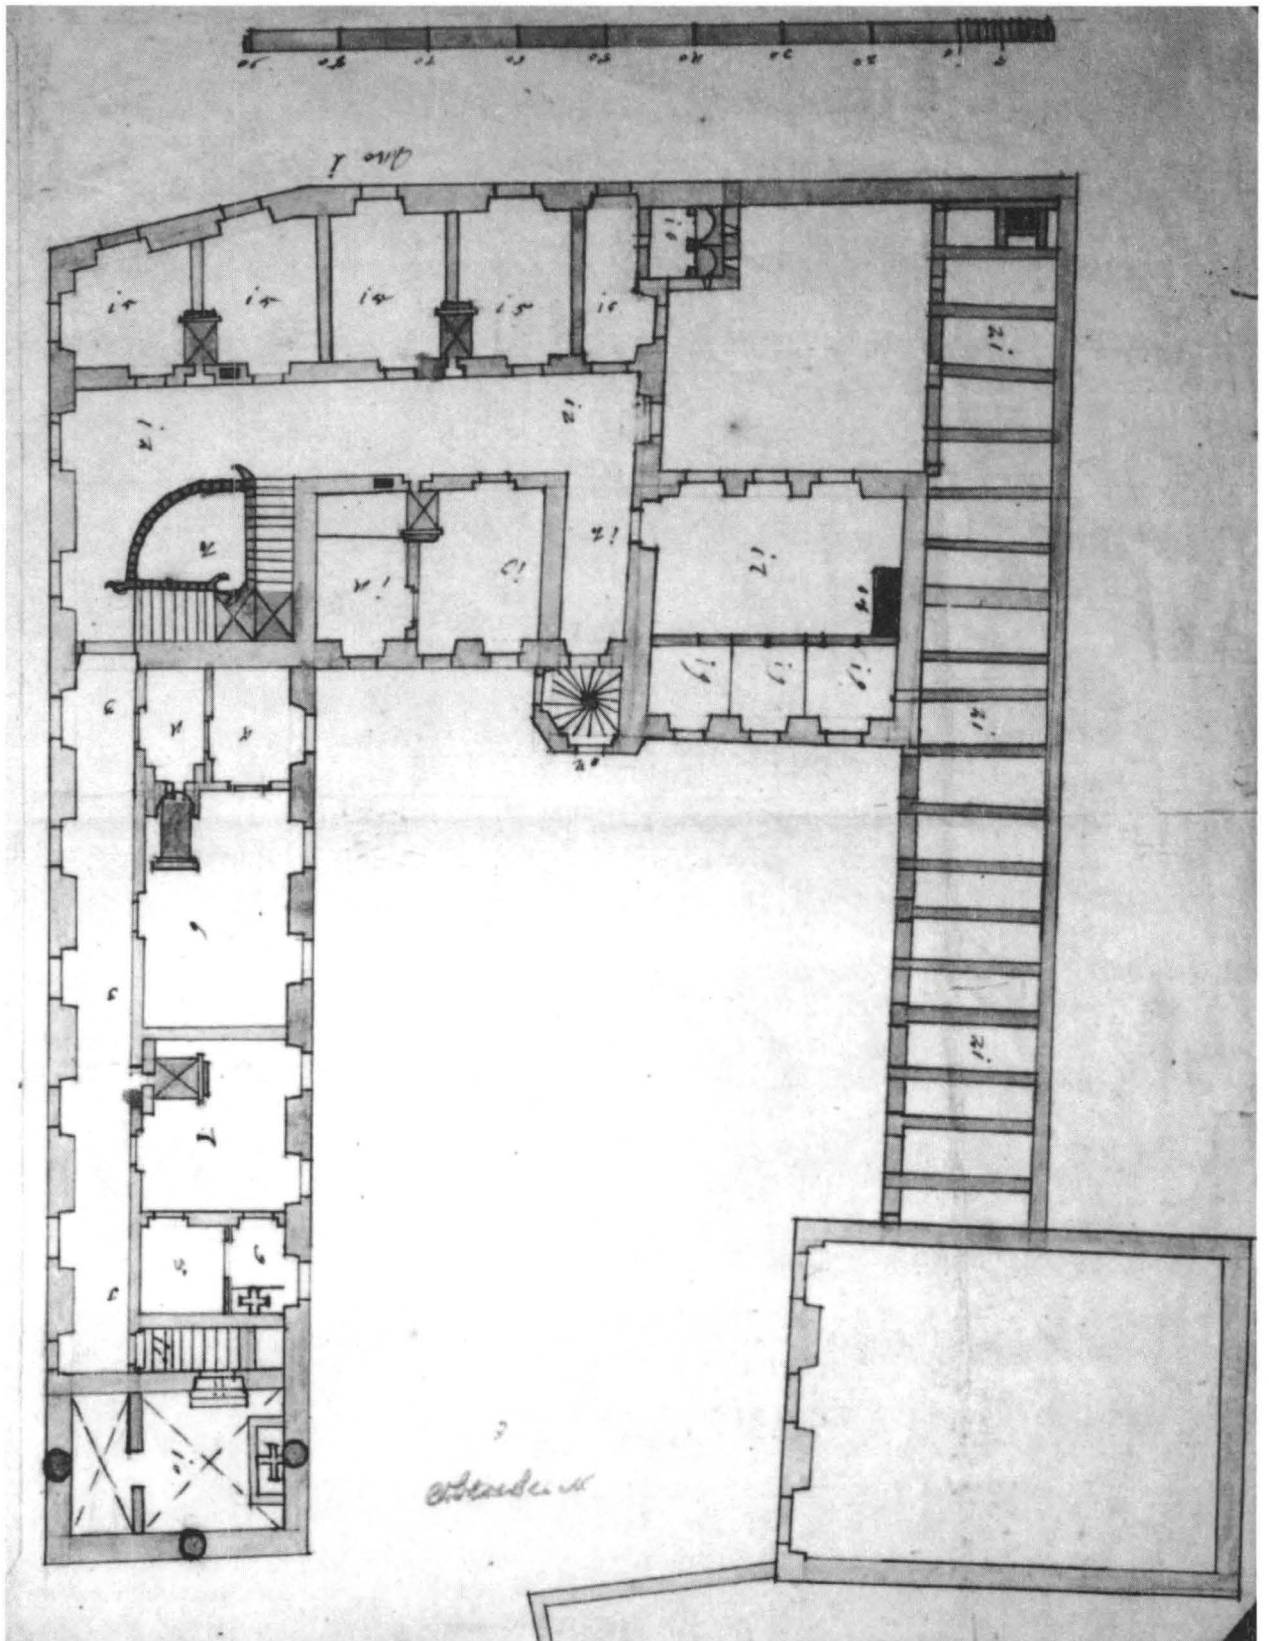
Grundriss des Obergeschosses, 1806 (Vorlage und Aufnahme: GLA, G Baupläne Freiburg / 2)
